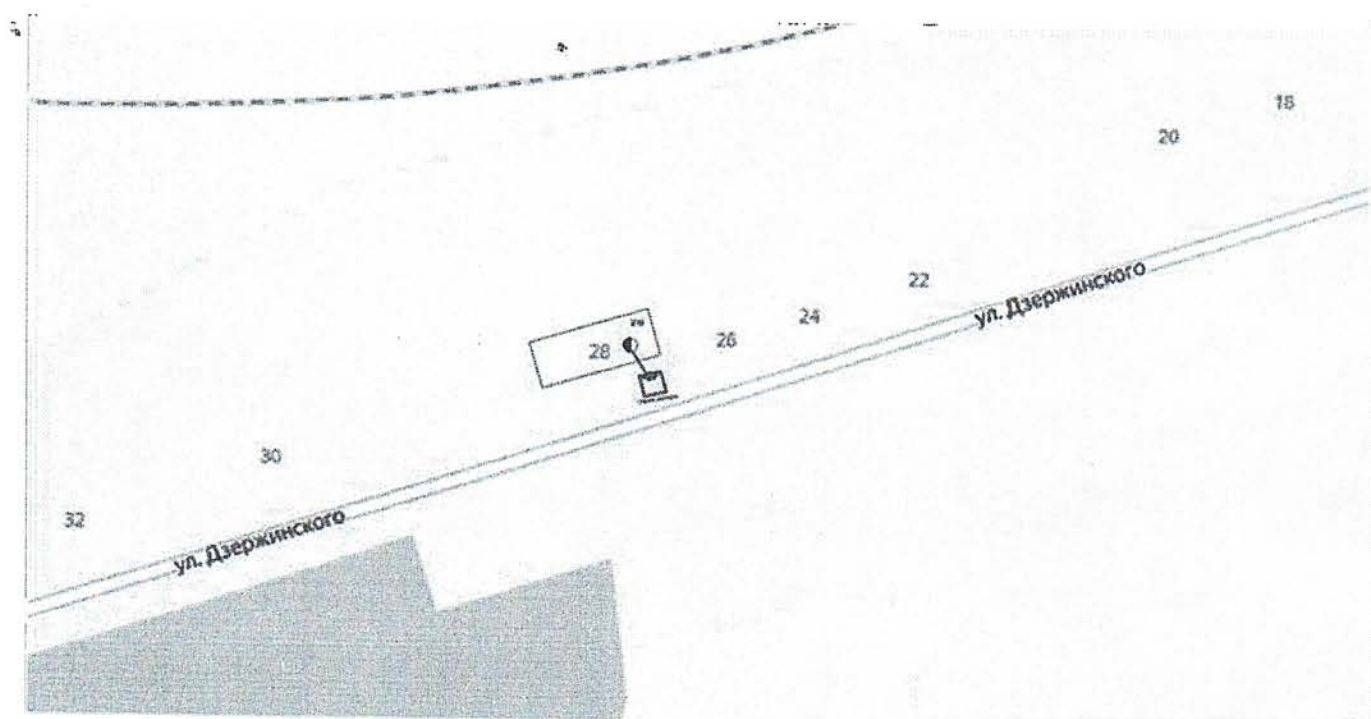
Схема теплоснабжения от котельной Известковая РСУ
